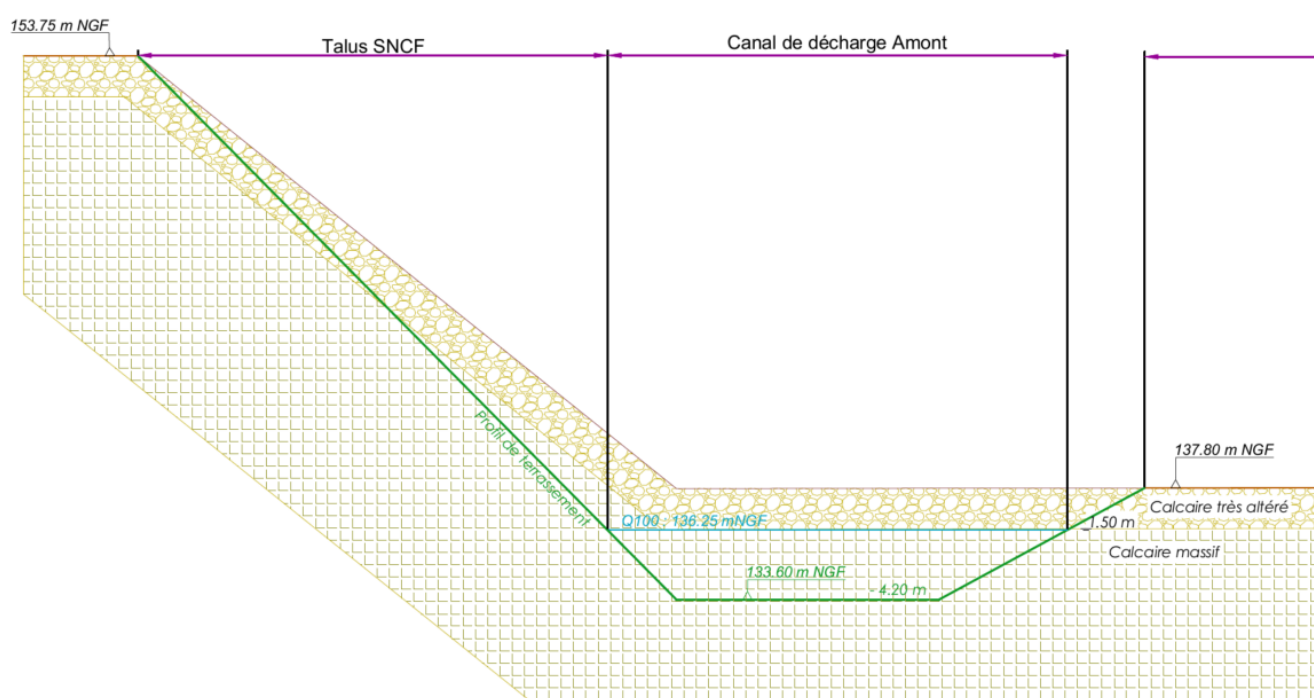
Coupe type de terrassement – Profil 2 - Secteur amont ATRIUM
